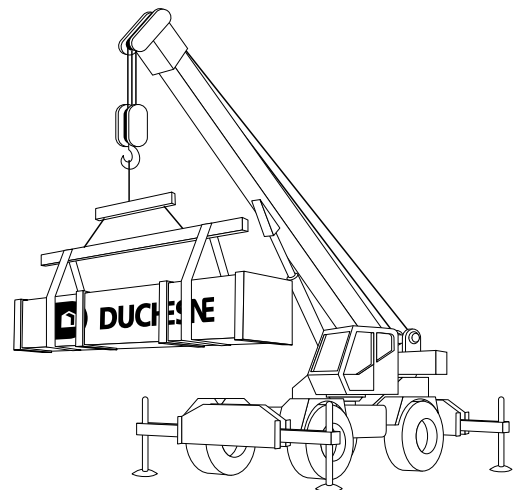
b | Manutention d'emballage de panneaux d'une longueur de 20 pieds (6 m) et plus.
